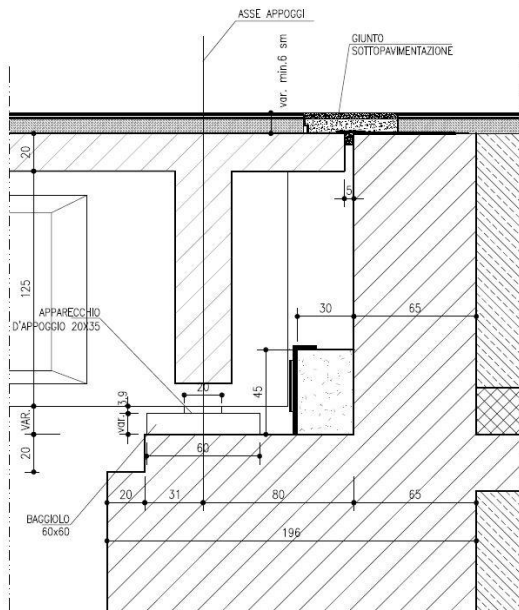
Sezione tipo struttura di sostegno in allargamento
